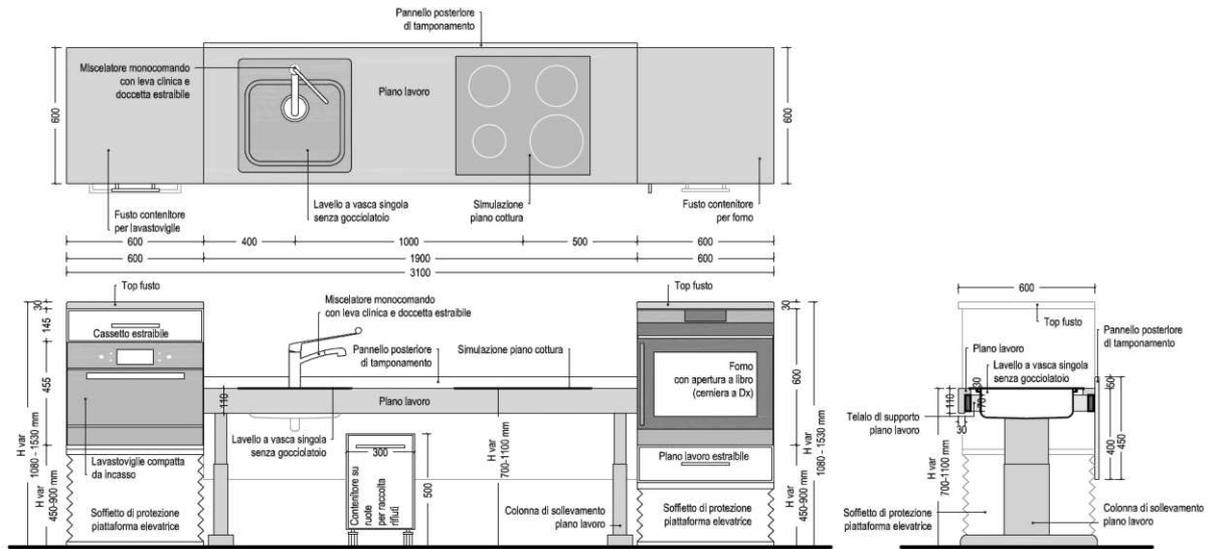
Pianta, prospetto frontale e sezione Blocco Preparazione
